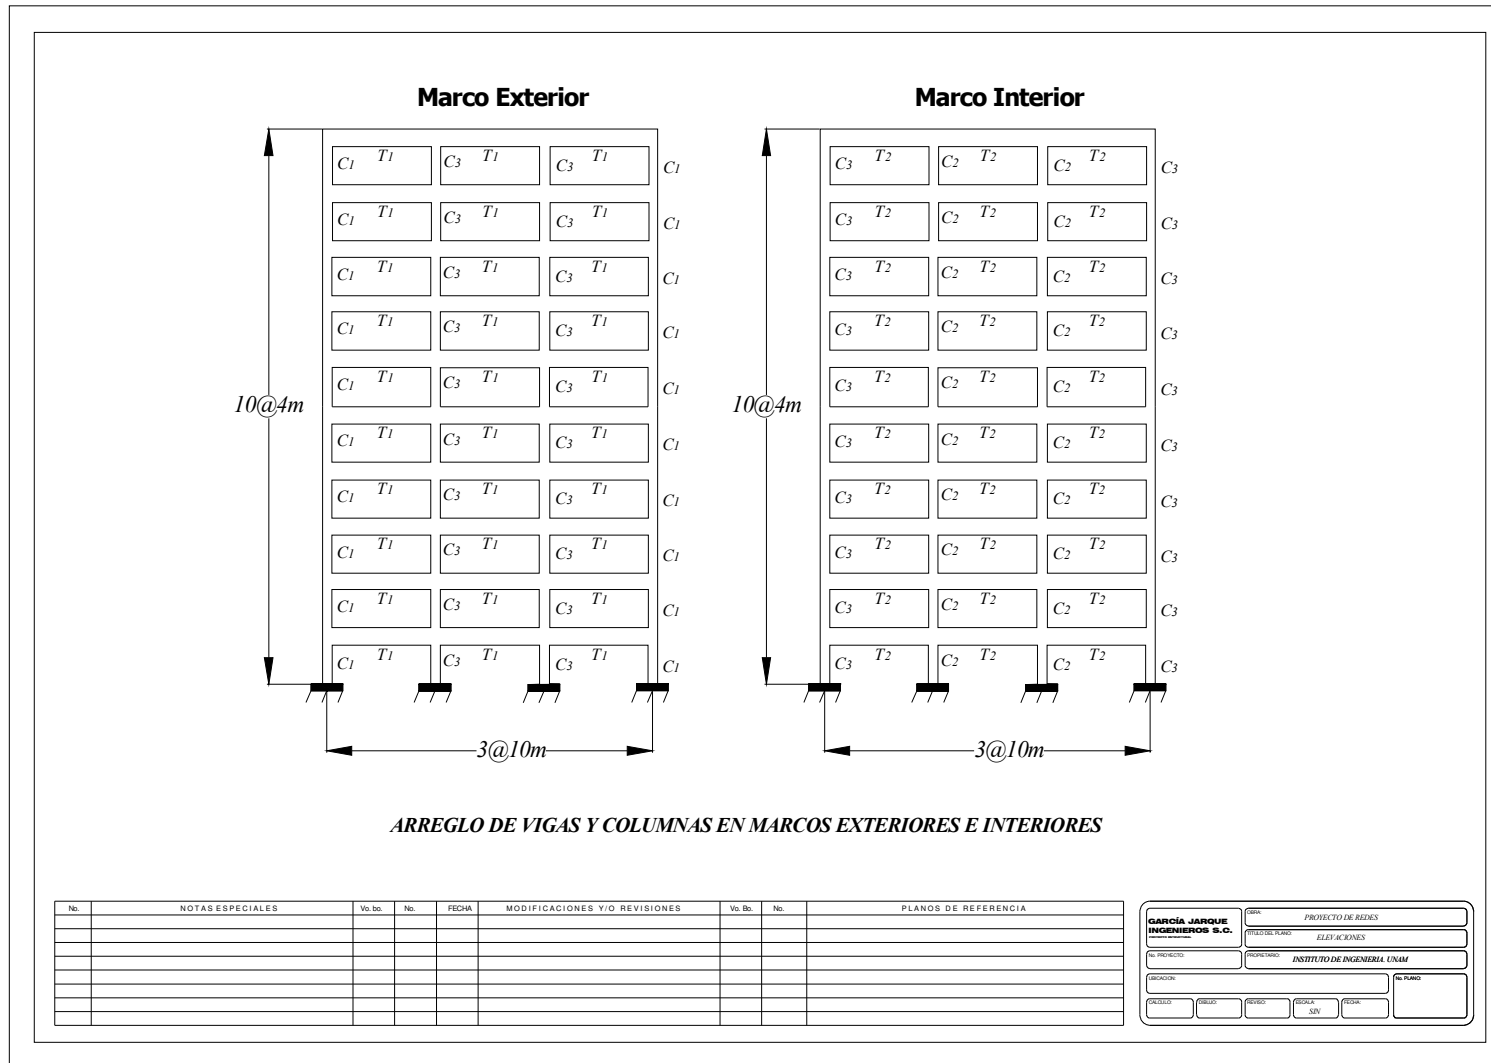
Secciones estructurales del edificio de 10 niveles
